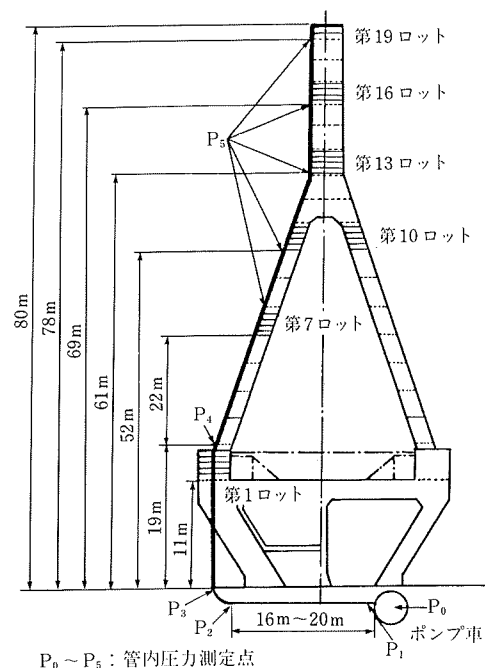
ポンプ圧送圧の計測位置の概要⁸⁾
